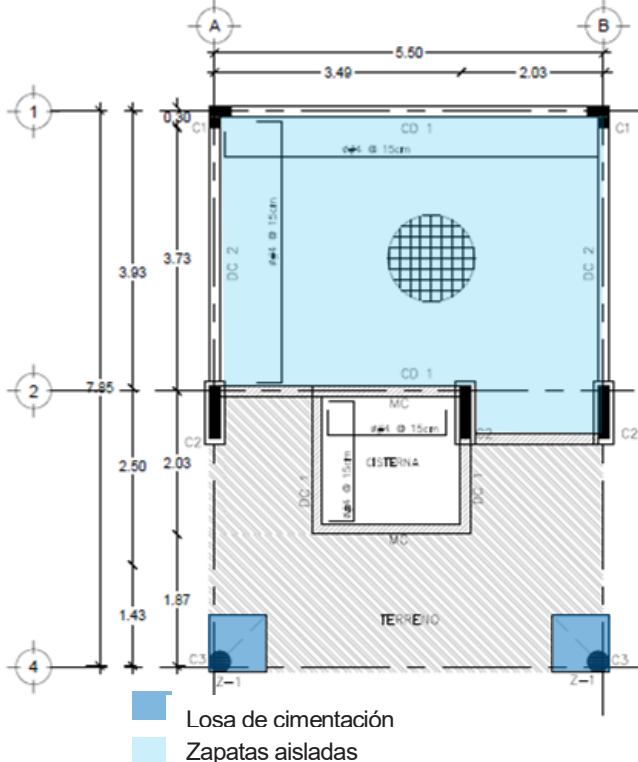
Detalle de la losa de cimentación y zapatas aisladas en cada módulo de vivienda.
